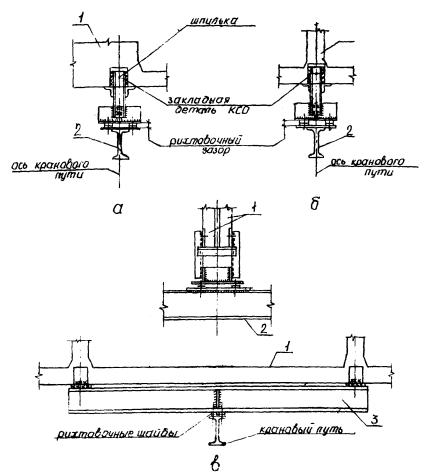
Уэлы крепления путей подвесного транспорта к нижним поясам ферм — диаграм КСО; 2-крановый путь; 3- распределительная балка
